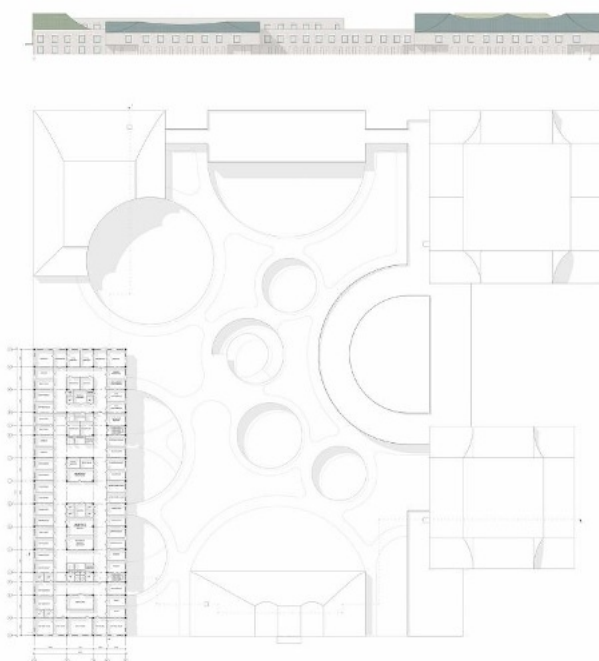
Ветеринарний комплекс в Києві, план 3-го поверху та фасад [19].
